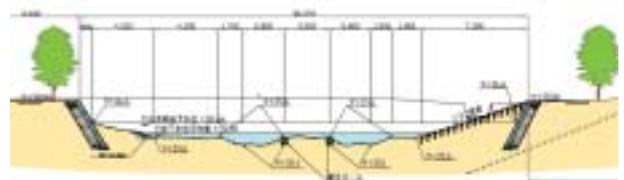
広瀬霞整備計画 横断面図（標準部 A-A断面）
